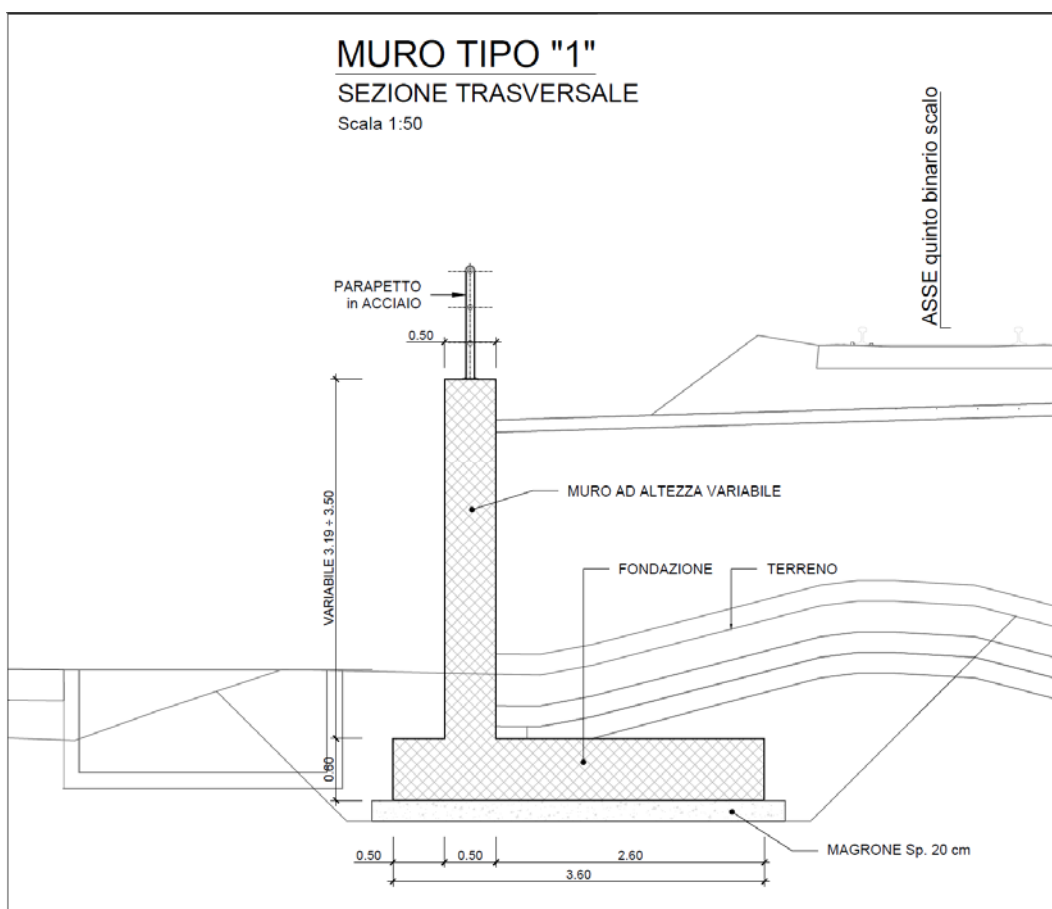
Sezione trasversale del muro MU08: tipo 1.
